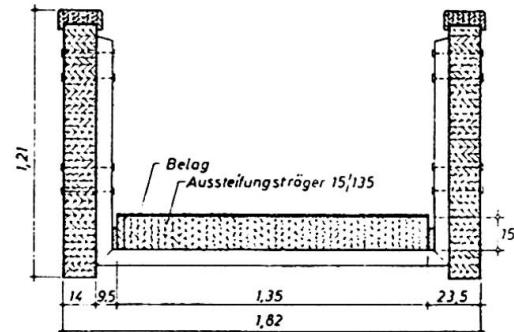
Brettschichtträger als Fahrbahn und als Horizontalaussteifung
